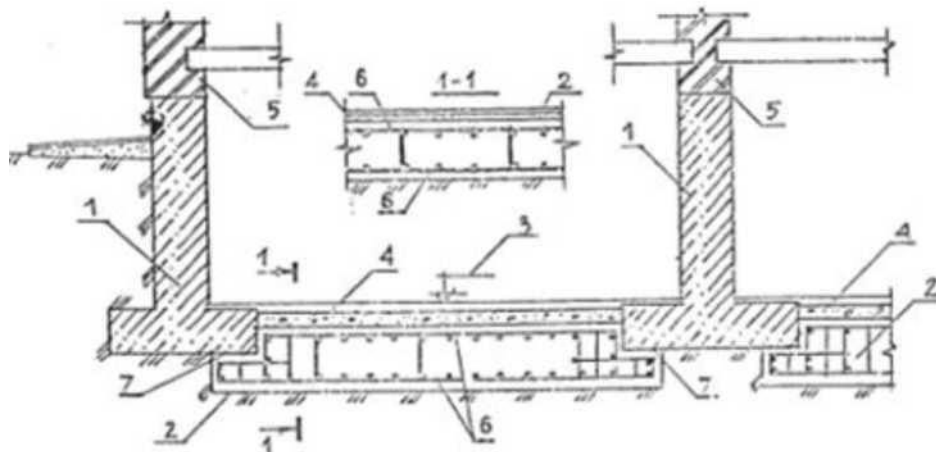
Устройство сплошной (прерывистой) плиты снизу подушек: 1- усиливаемый ленточный фундамент, 2- сплошная (прерывистая) плита; 3- отметка поверхности пола подвала; 4- уплотненный крупный песок; 5- кирпичная стена; 6- рабочая арматура плиты усиления; 7- поверхность фундамента, подготовленная к бетонированию.
